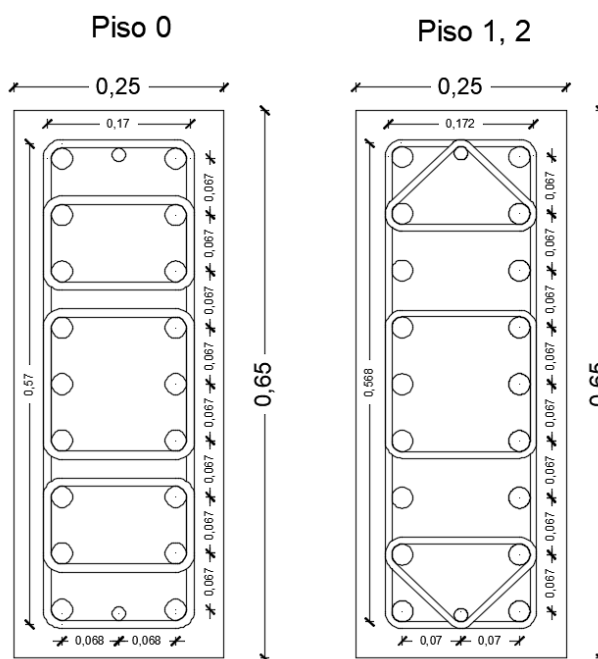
Configuração de armaduras do pilar-exemplo
